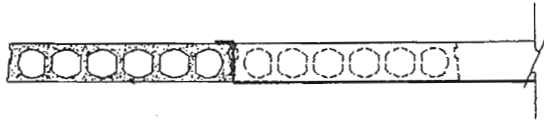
Hollow Core Slab on RC. Beam with Side Support.
